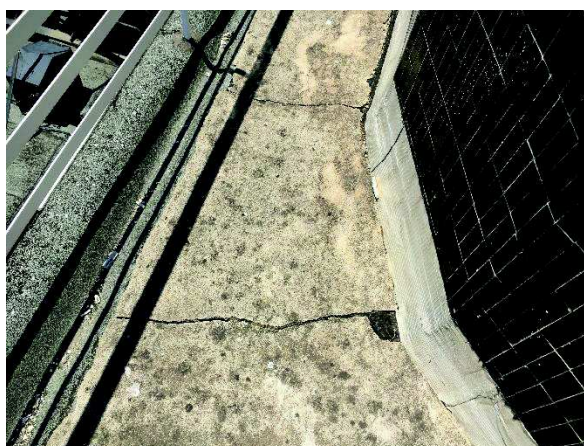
Impermeabilização de terraço Fonte: Fotografia própria
